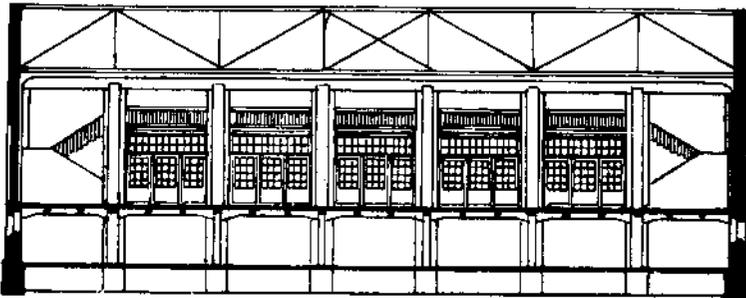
Внутренний вид помещения, перекрытого железобетонным шедом.
